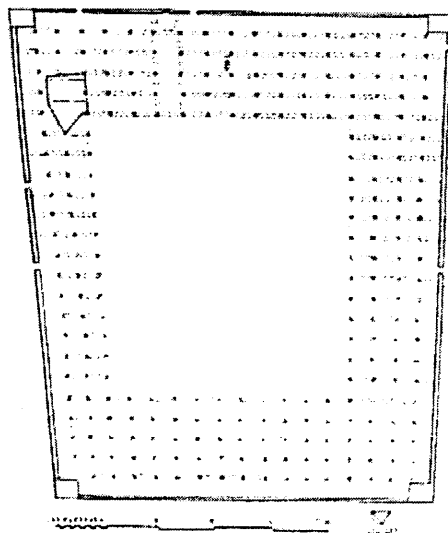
رسم تصوري للمسقط الأفقي لمسجد عمرو بن العاص سنة إنشائه
